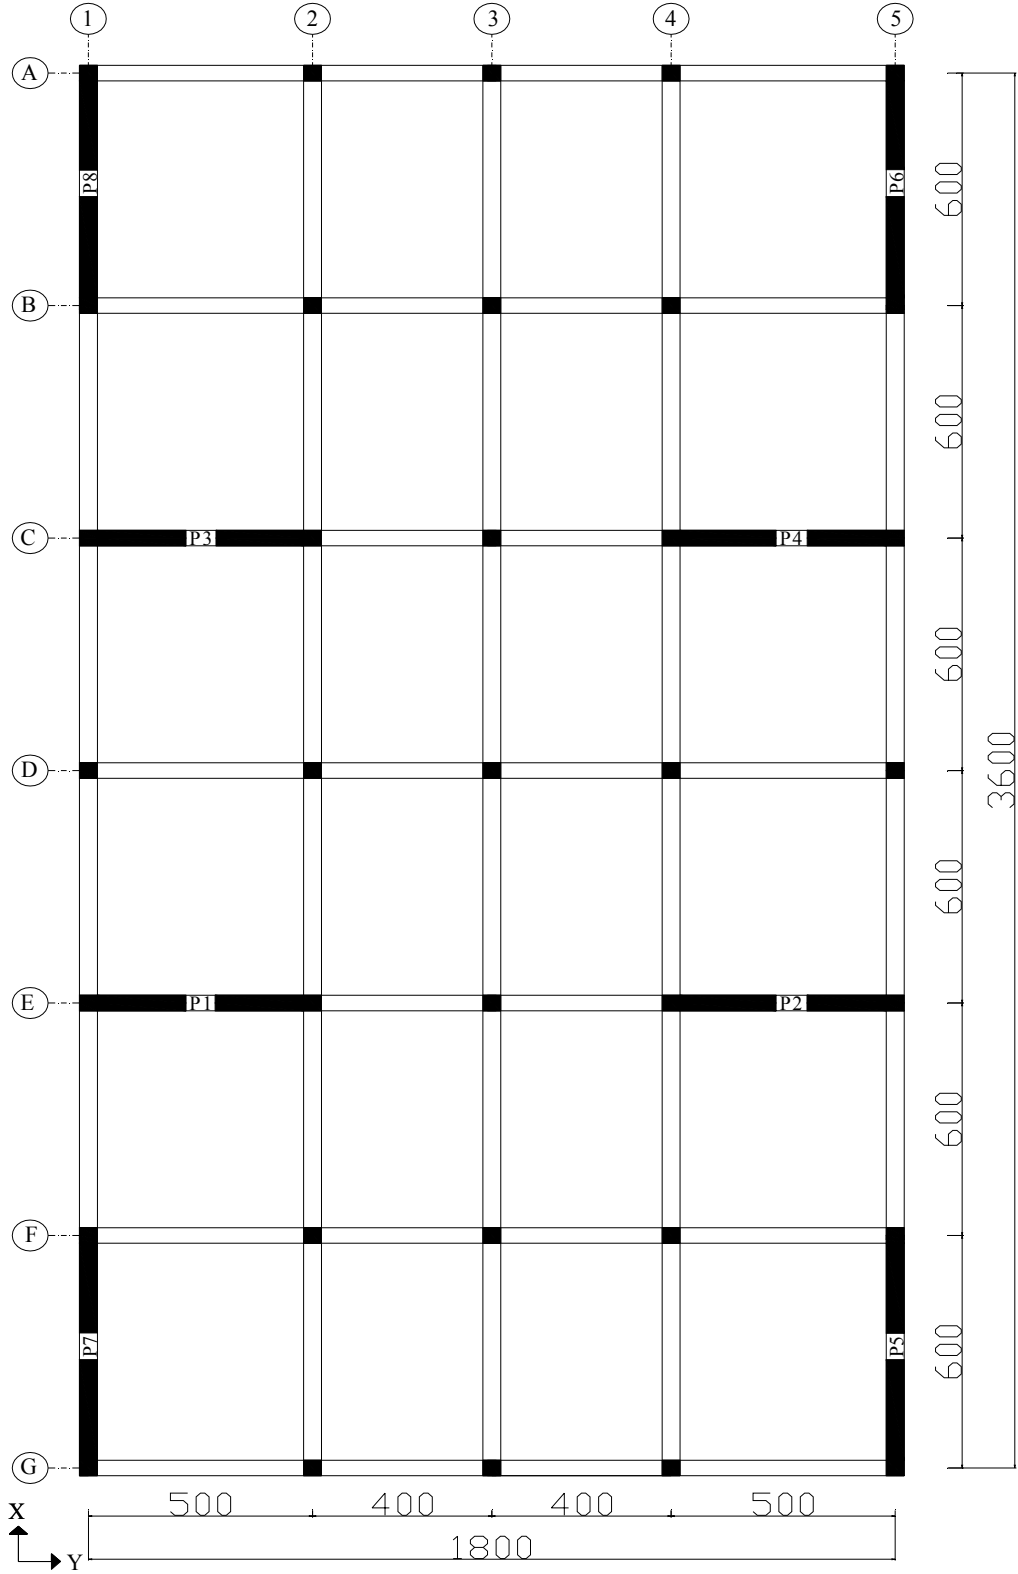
Örnek 5.14'ün kat kalıp planı
